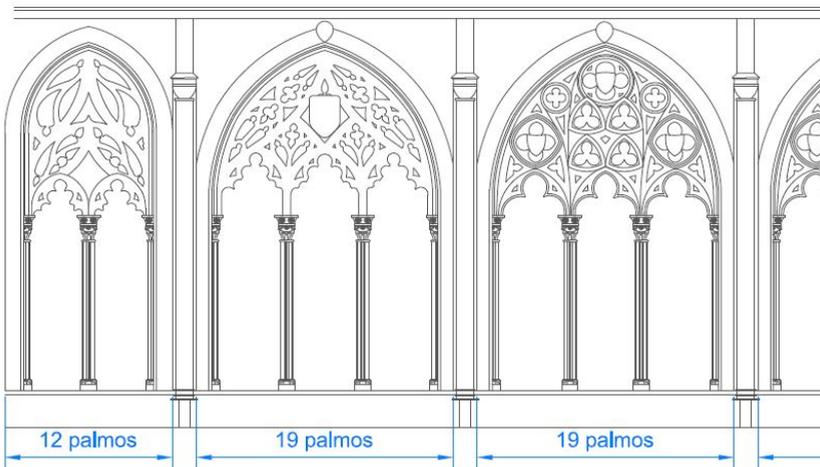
Detalle de Alzado Este acotado en palmos. 2016. Plano del autor.
